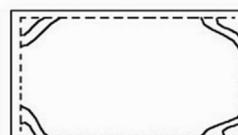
Fissuração por deficiência de armaduras para combate aos momentos ventolentes, na face superior da laje
